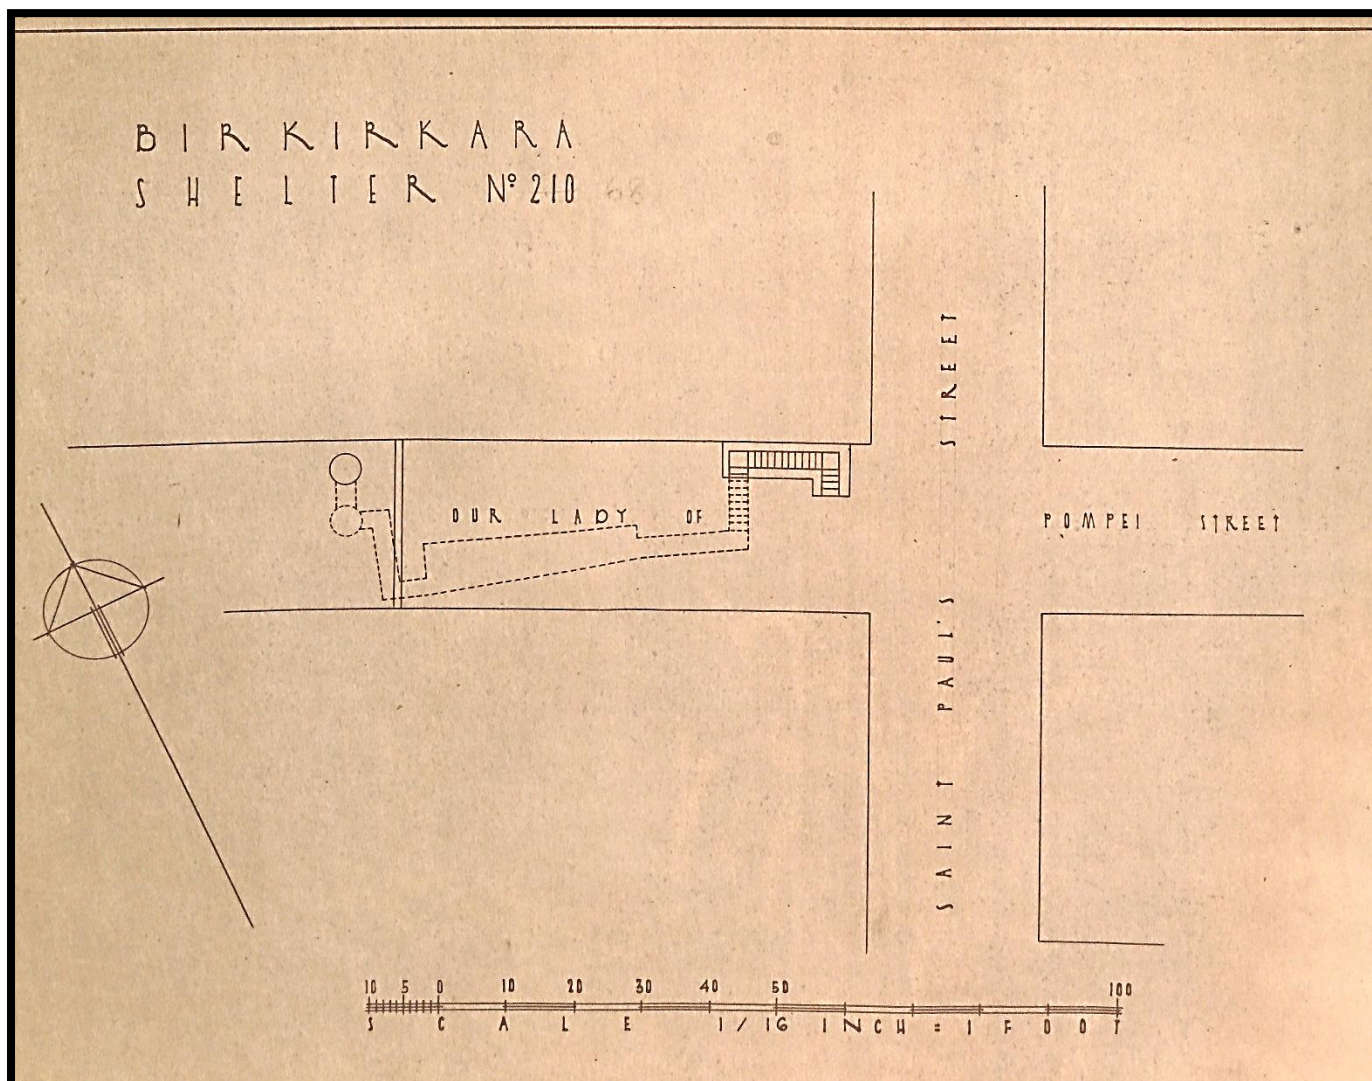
Planta do Abrigo nº 210 (68) "Saint Paul Street – Our lady Of Pompei Street."
